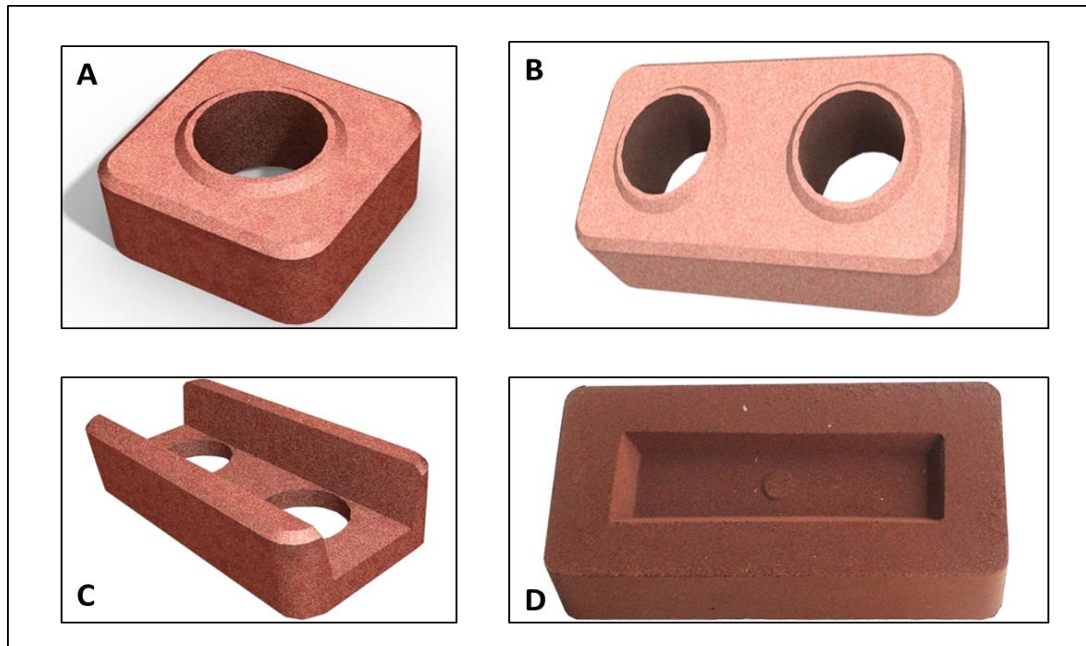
Tipos de blocos de cimento. A: Meio tijolo de solo-cimento. B: Tijolo Modular de solo-cimento. C: Tijolo Canaleta de Solo-cimento. D: Tijolo Maciço de solo-cimento.
